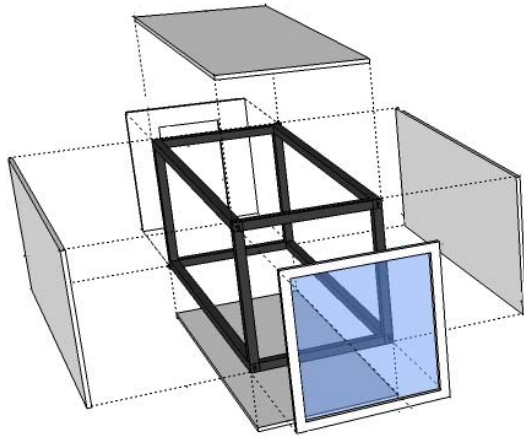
Fachada à frente da estrutura (variante I) <sup>[160]</sup>
